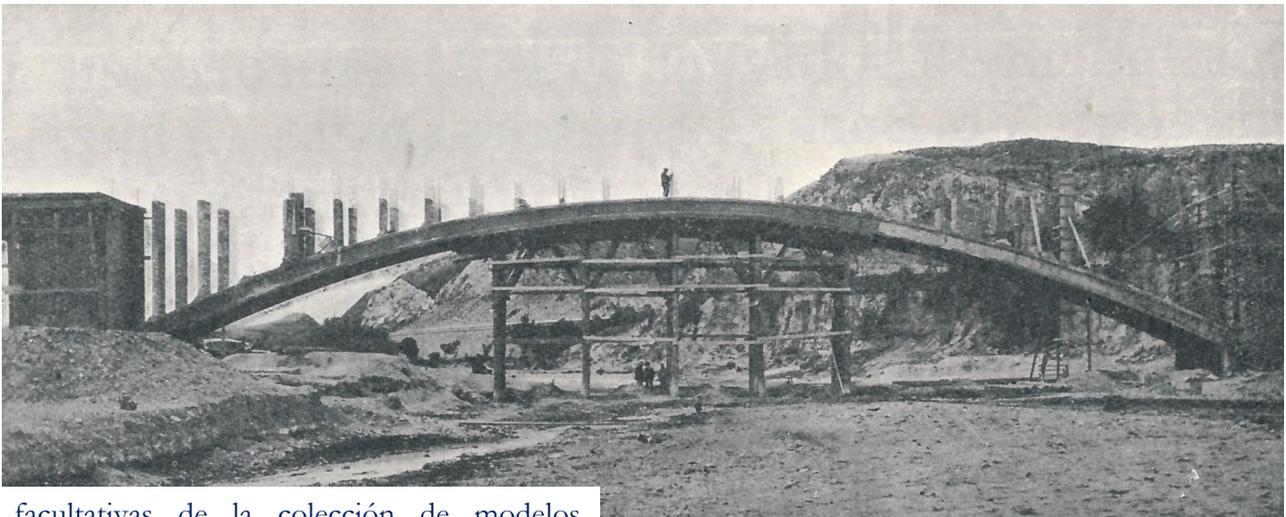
Detalles constructivos del armado del puente viaducto de Purchena. [14]. Archivo General de la Administración
